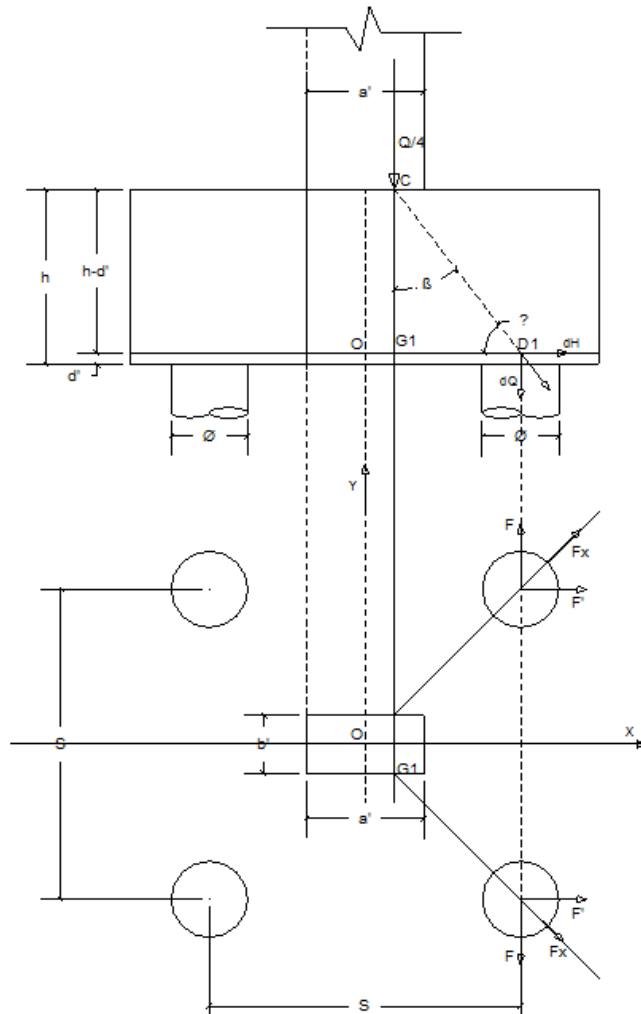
22: Método de las bielas comprimidas para cabezales sobre 4 pilotes- columna rectangular.
